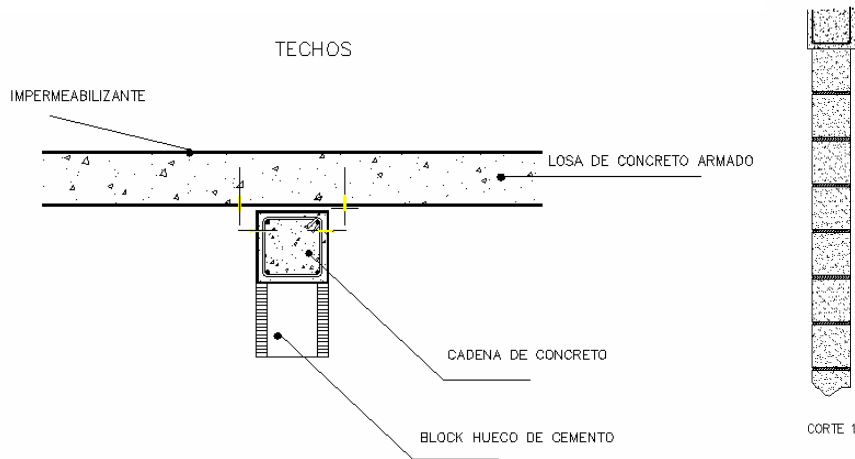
Corte de Techos y Muros de la Vivienda Tipo.
